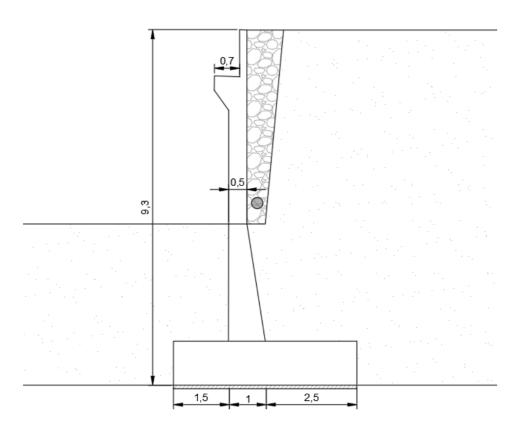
Geometría del estribo de Portugal (Fuente: Propia)
